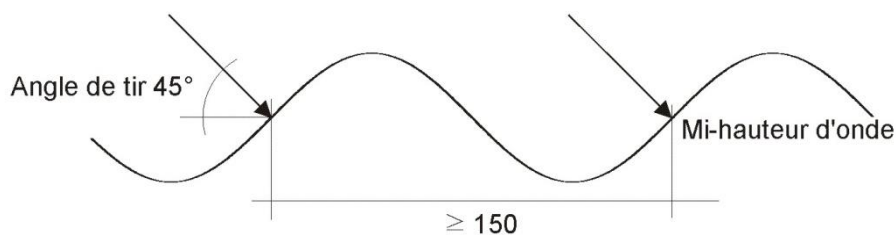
Points d'impact et angle de tir pour une plaque en fibres-ciment profilée de toiture, ici à l'exemple d'une plaque ondulée (dimensions en millimètres).
